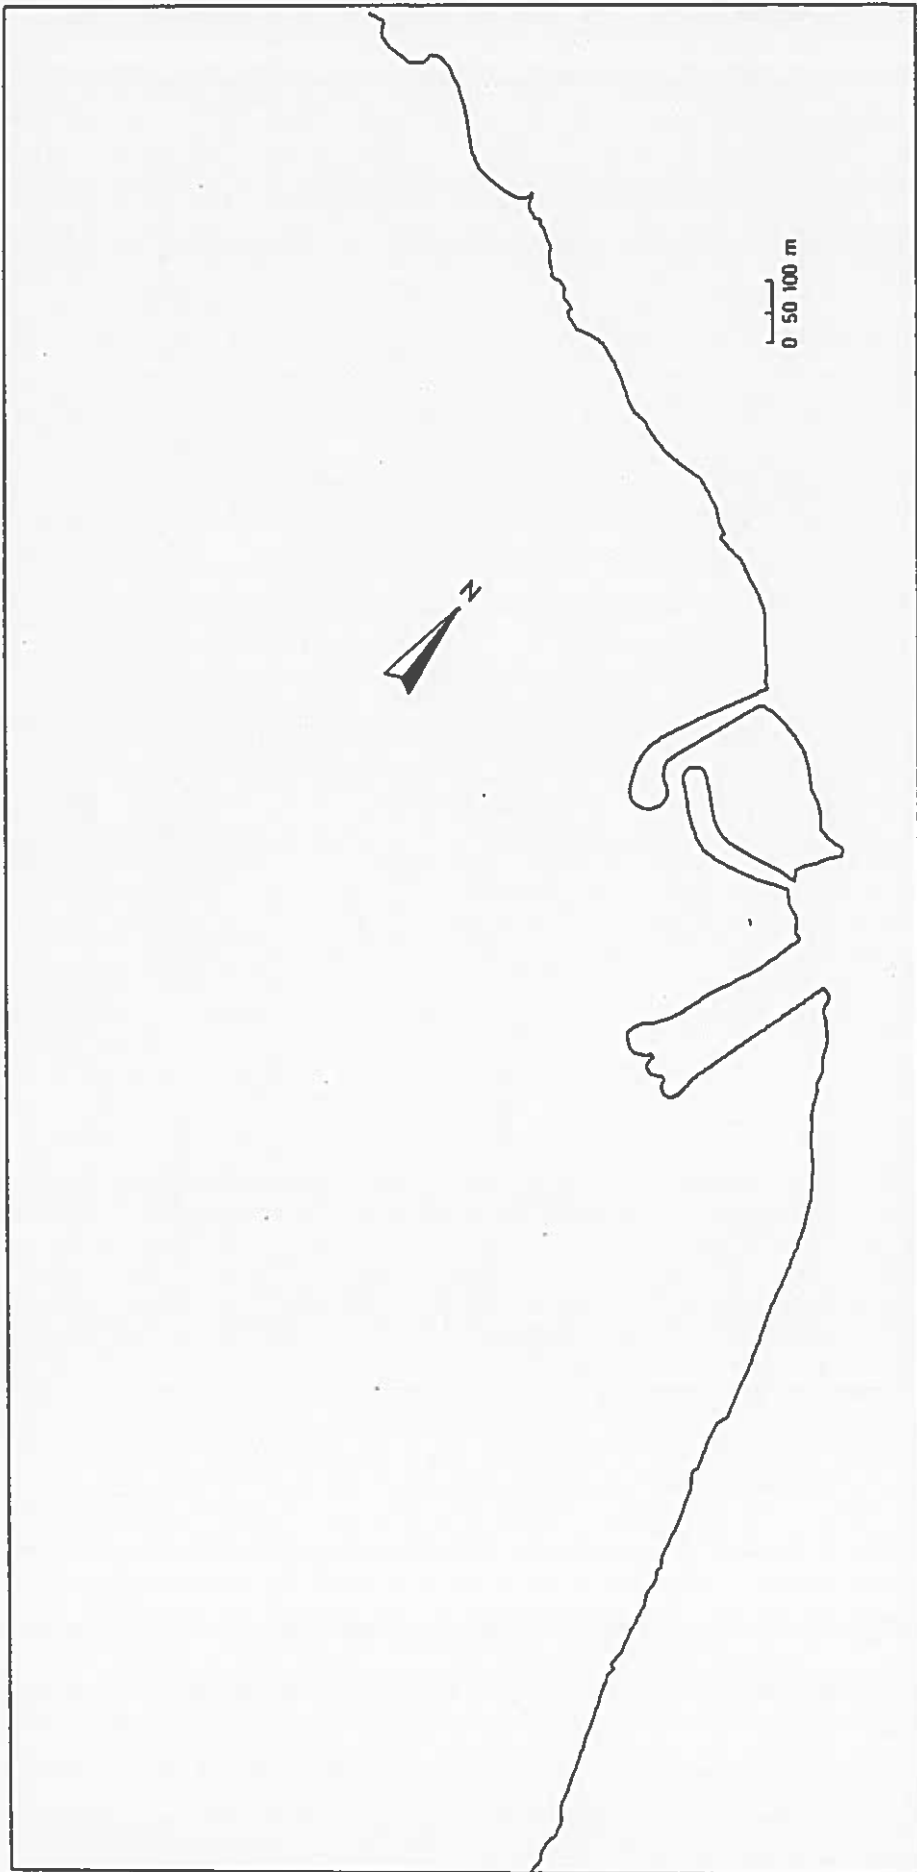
Configuração em planta dos dispositivos de captação e de rejeição
